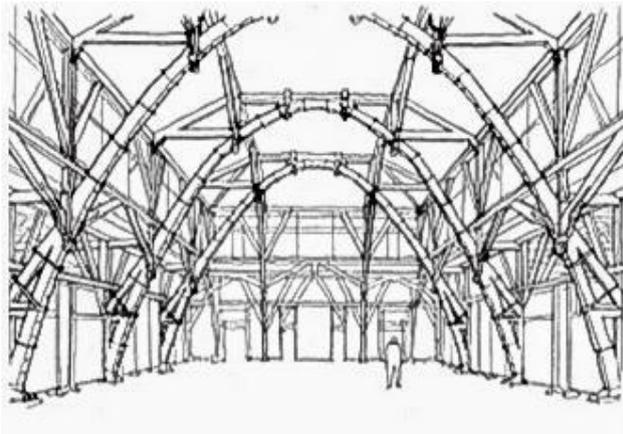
Instituto tecnológico de Bandung, Indonesia 1920, Henri, Plano elevado.
